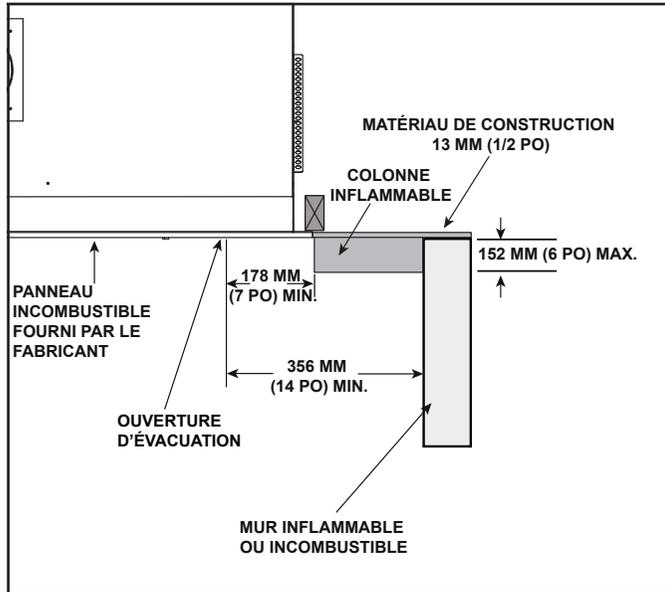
Pieds de manteau de foyer et saillies du mur inflammables
